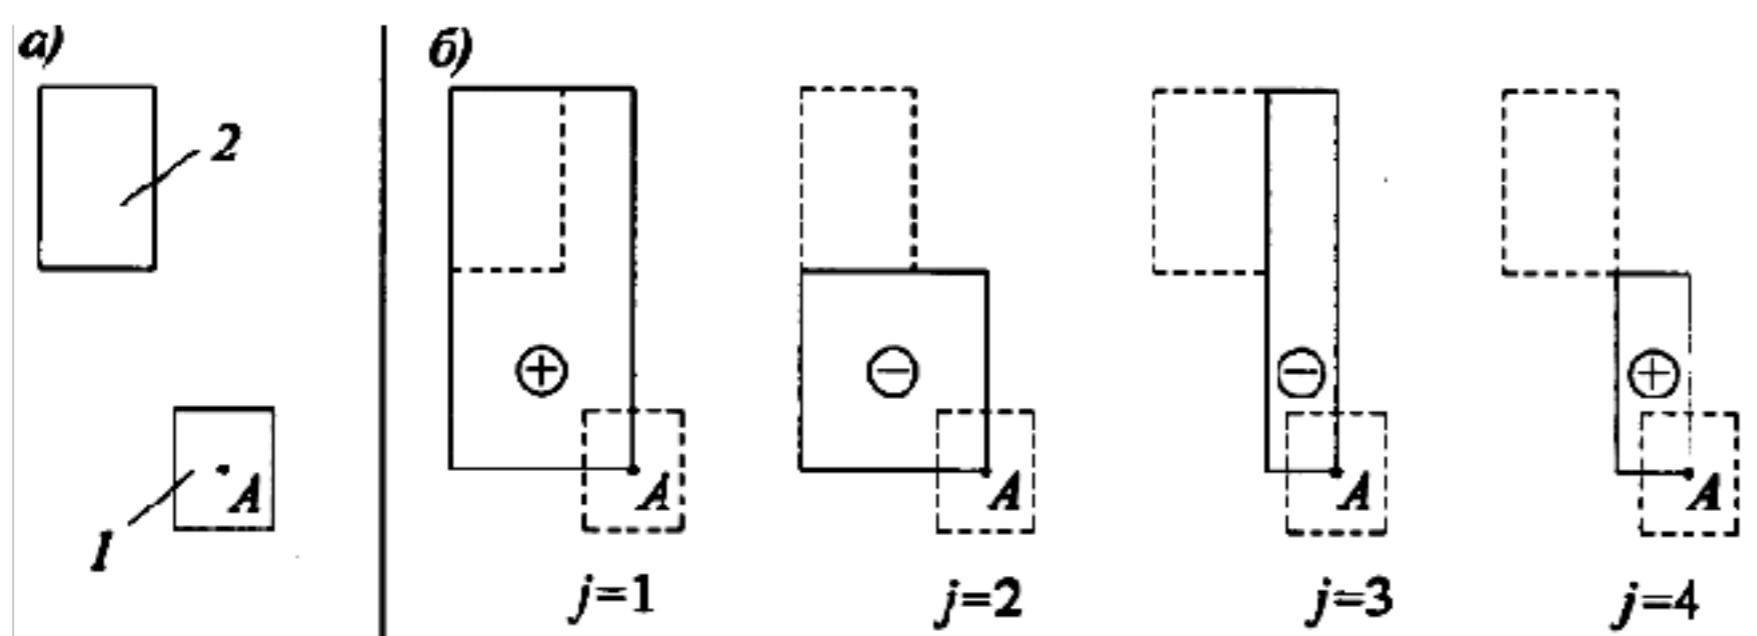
Схема к определению вертикальных напряжений в основании рассчитываемого фундамента с учетом влияния соседнего фундамента методом угловых точек: а - схема расположения рассчитываемого 1 и влияющего фундамента 2; б - схема расположения фиктивных фундаментов с указанием знака напряжений  $\pm z_{r,cj}$  - в формуле (3.6) под углом  $j$ -го фундамента
